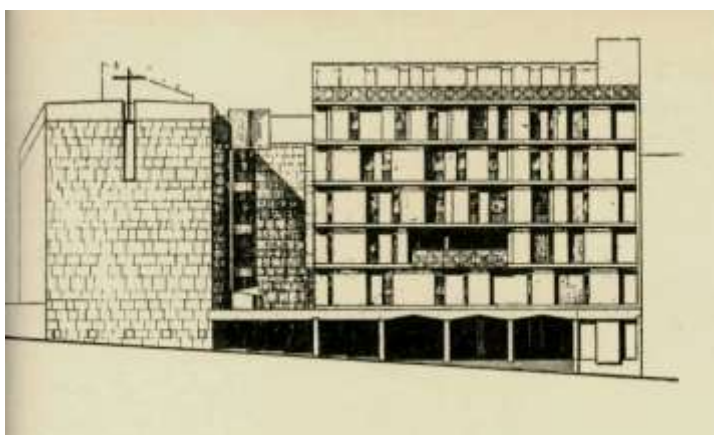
Alçado da Igreja e Centro Paroquial – revista *Arquitectura* nº76, p.27
